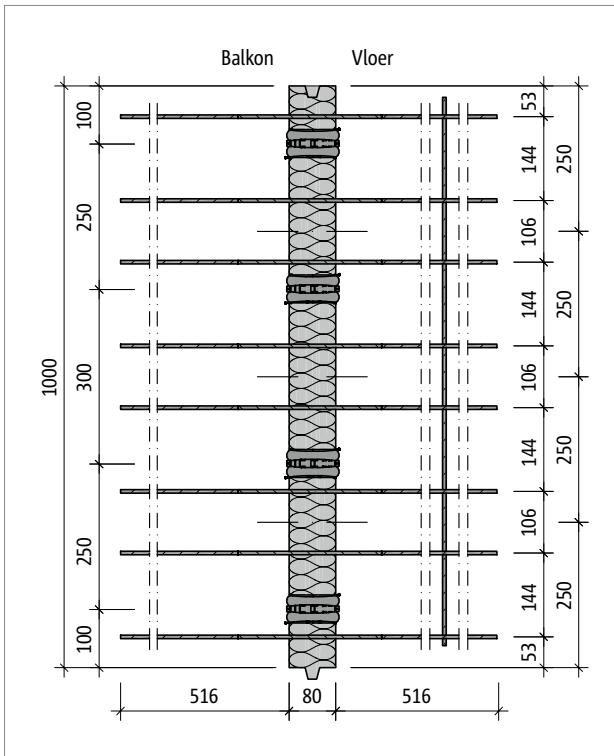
Schöck Isokorb® T type Q-T-W-V1 tot V2: Doorsnede
